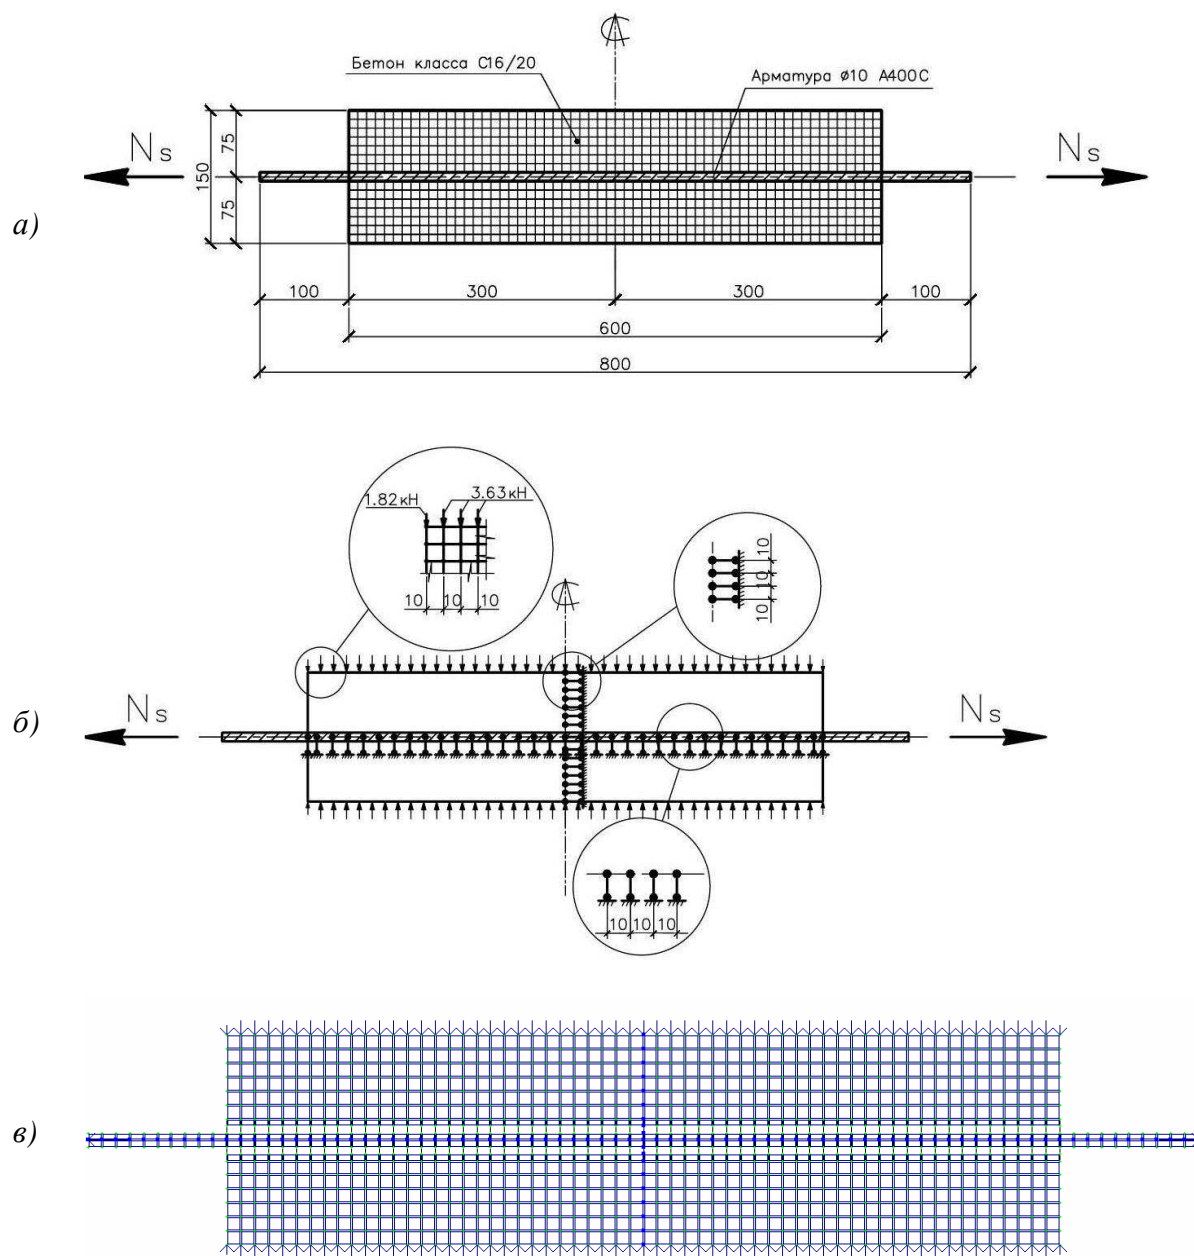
Плоская модель сцепления арматуры с бетоном: а – общий вид модели; б – схема расположения опор и нагрузка; в – расчетная схема модели в ПК Лира-САПР
